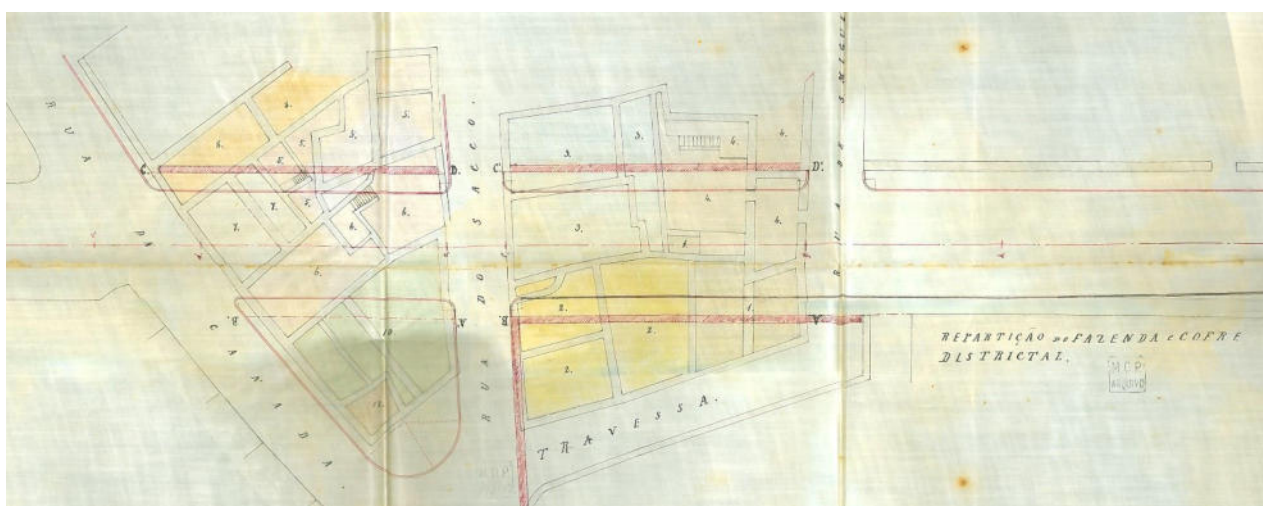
Detalhe da planta no Anexo 8 com identificação dos imóveis a expropriar.
